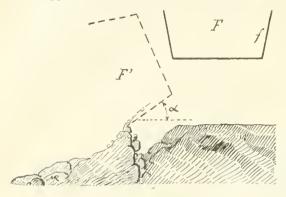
Fig. U. — Coupe transversale du coffre d'une brouette du type franças.
